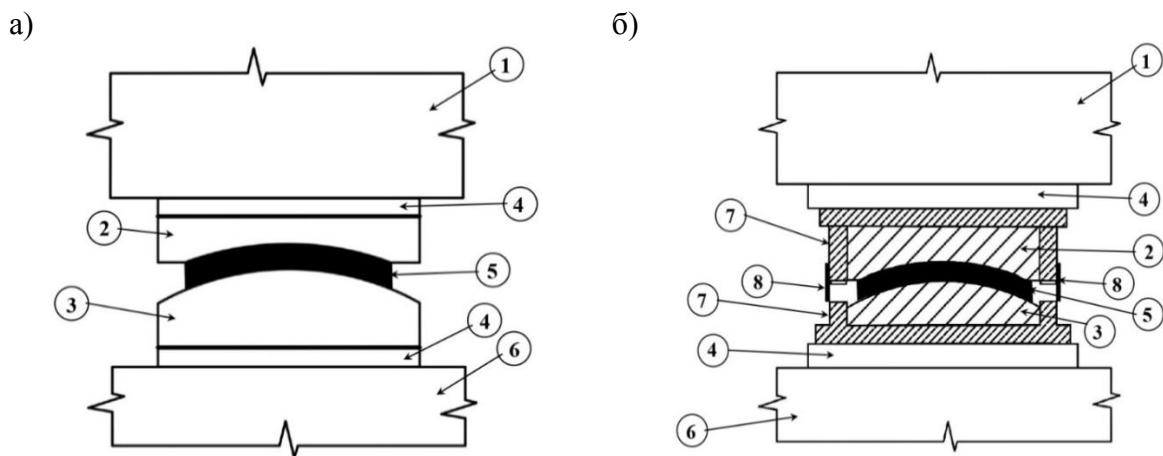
Резинометаллические опорные части с цилиндрической поверхностью в рабочем положении:
